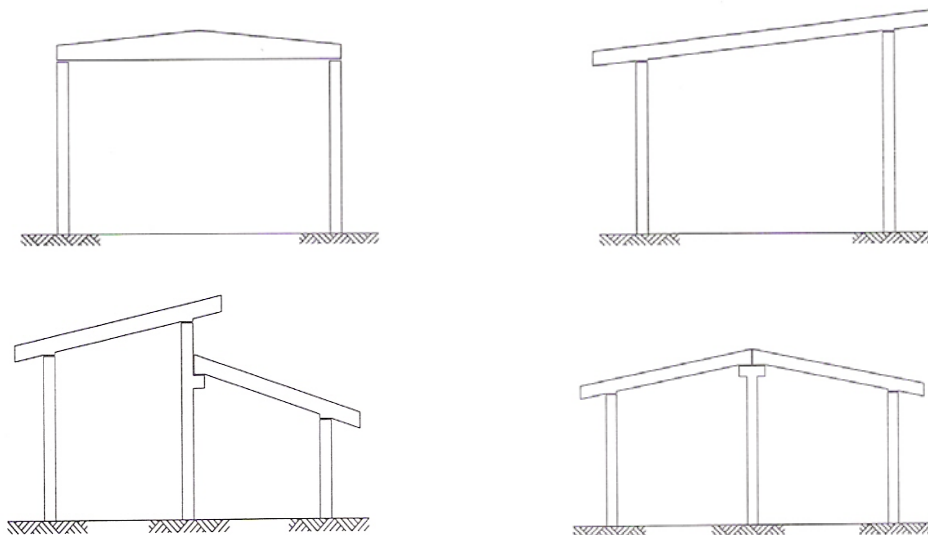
Sistema aporticado com ligação rígida entre os pilares e os elementos de cobertura
